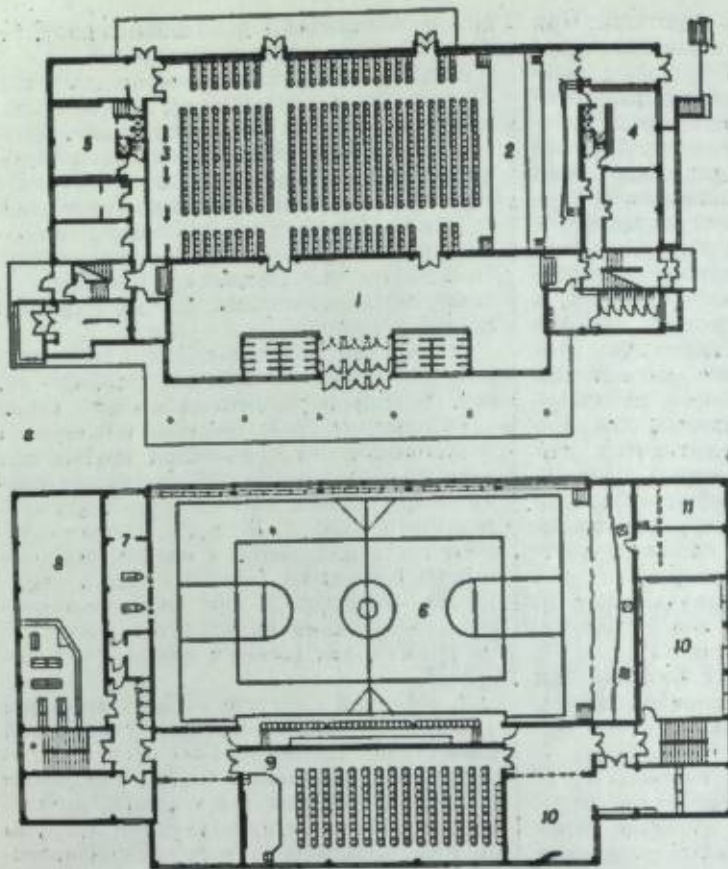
Клуб с универсальным зрелищно-спортивным залом для городского микрорайона: а — план 1-го этажа, б — план 2-го этажа; 1 — вестибюль-фойе; 2 — зрительный зал на 600 мест со сборно-разборной эстрадой; 3 — помещение для хранения мебели; 4 — артистические раздевалки; 5 — раздевалки для спортсменов; 6 — зрительный зал, трансформированный в спортивный (размер 15 м × 30 м); 7 — киноаппаратная; 8 — библиотека; 9 — аудитория; 10 — кружковые комнаты; 11 — склад бутифории.
